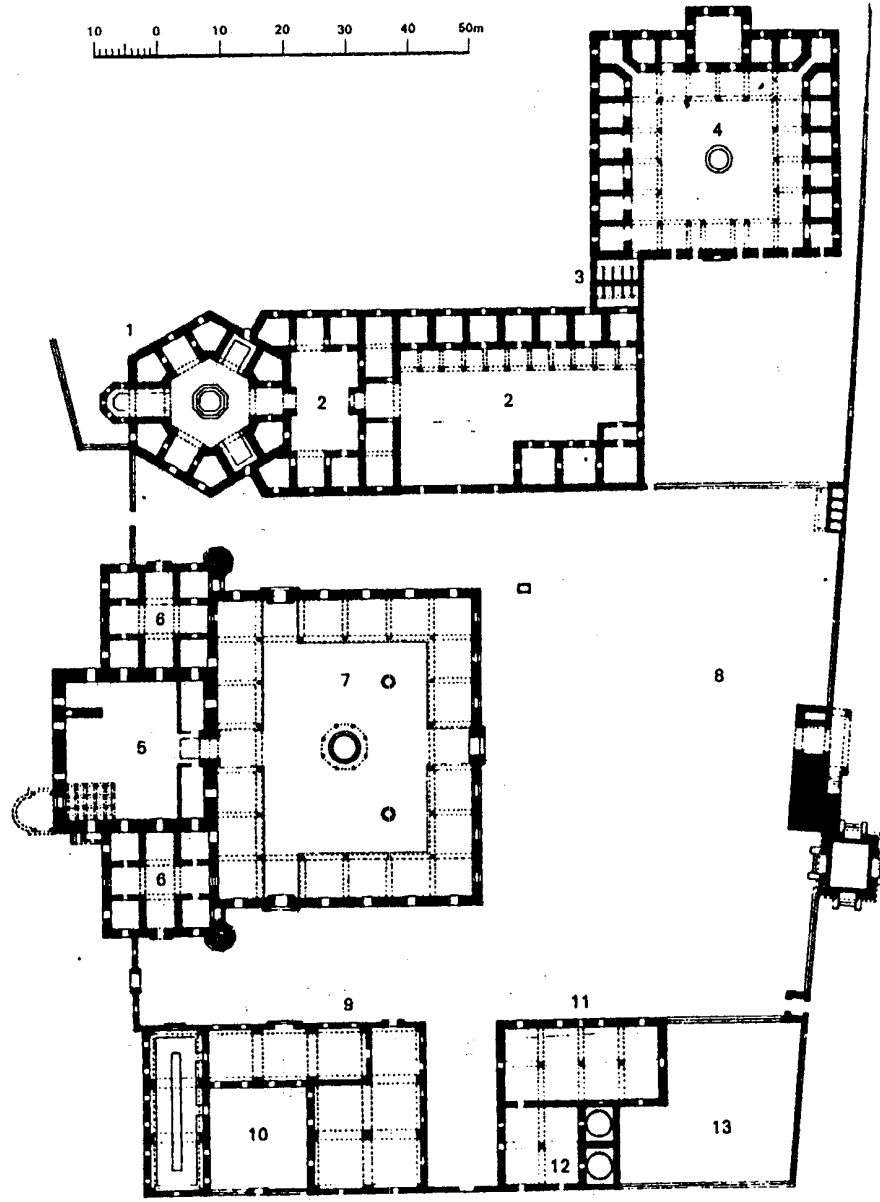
مسقط أفقي لمدرسة بايزيد يلدريم ضمن مجمعه في بورصة أو بروسه
